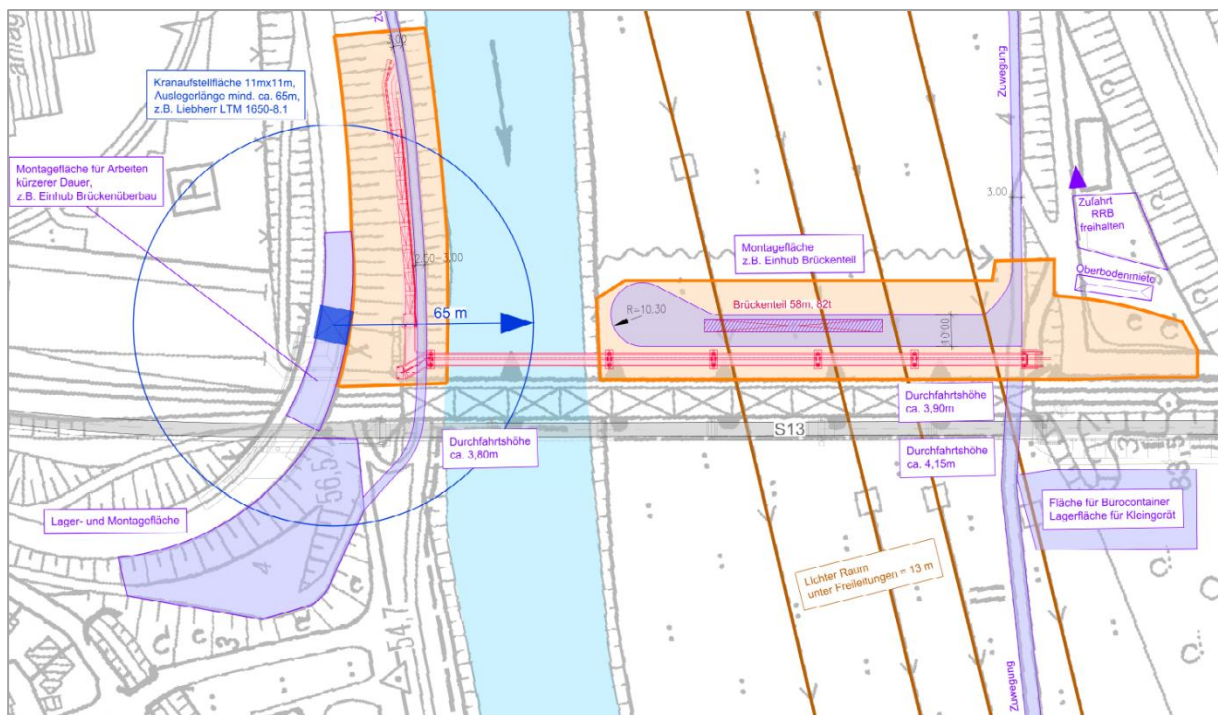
Lage der Bauwerke und Baustellenfläche aus der Anlage 06 Baustelleneinrichtungsplan der Planfeststellungsunterlagen [3]
